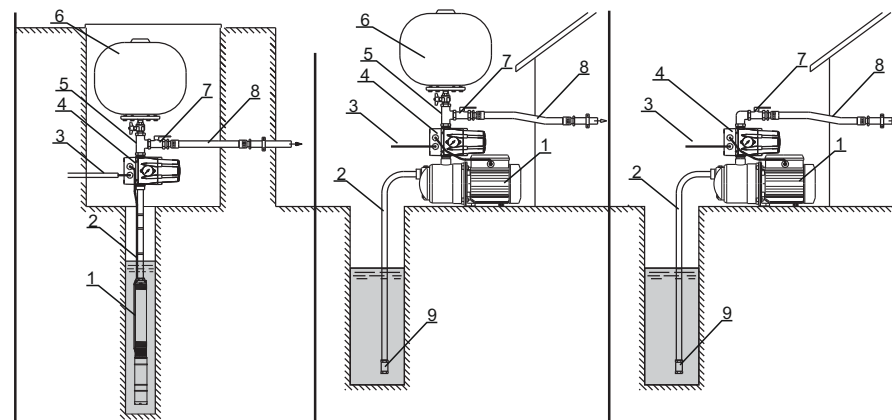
Установка с погружным насосом Рисунок 2. Установка с поверхностным насосом Рисунок 3. Установка с поверхностным насосом без дополнительного резервуара
